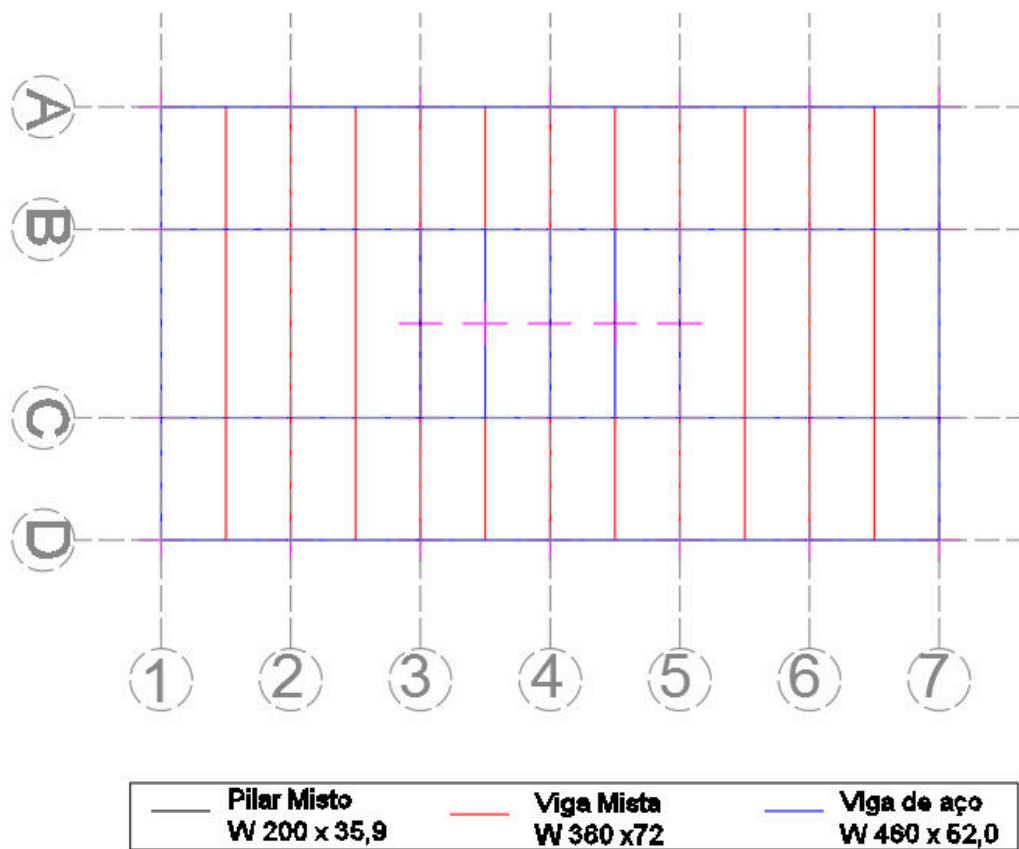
Modelo estrutural, vista superior das vigas do pavimento tipo.
